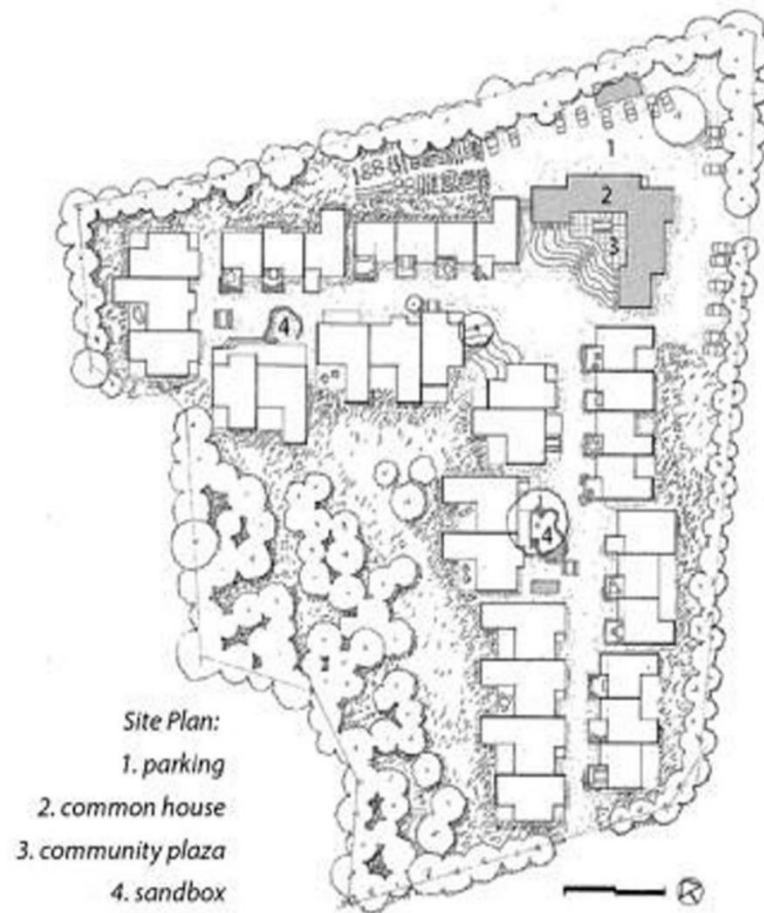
Diagrama da planta baixa do Trudslund Chousing ilustrando configuração espacial característica de uma vila cohousing. Fonte: McCamant ; Durrett (2011)
